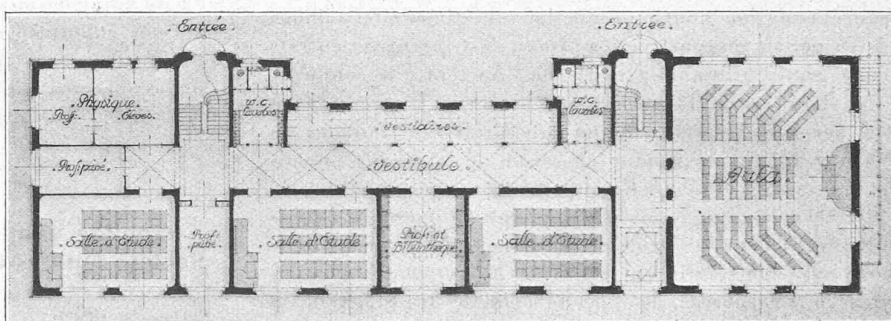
Plan du rez-de-chaussée supérieur. — 1 : 500.
